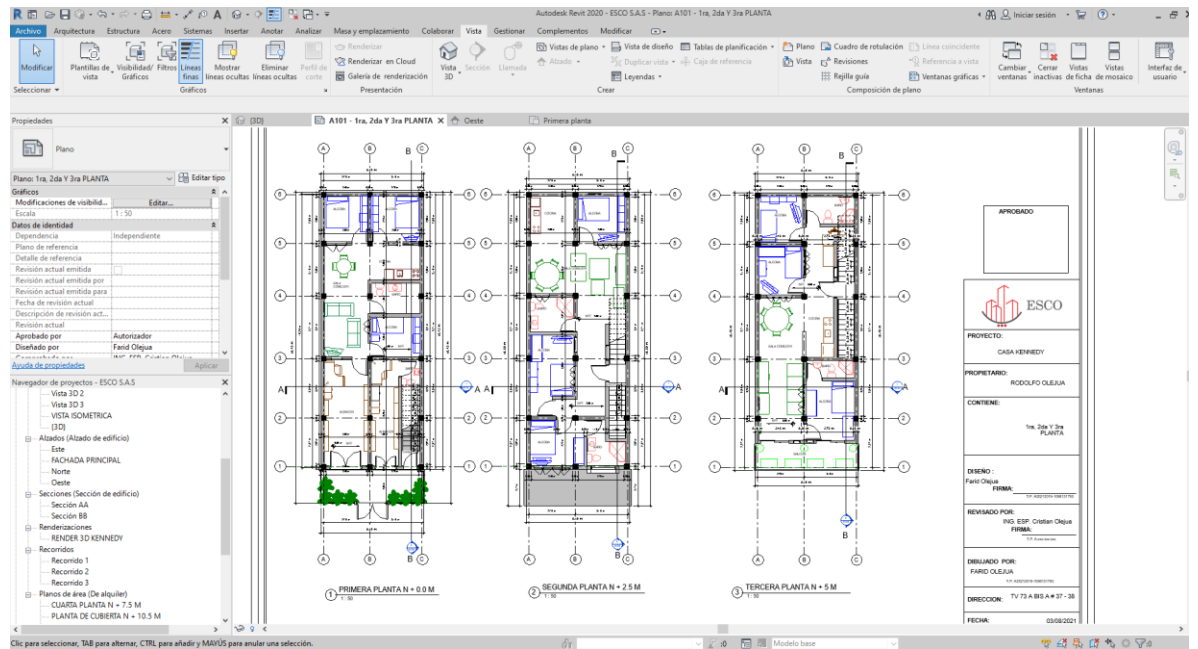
Primera, segunda y tercera planta. Revit. Fuente elaboración propia.
